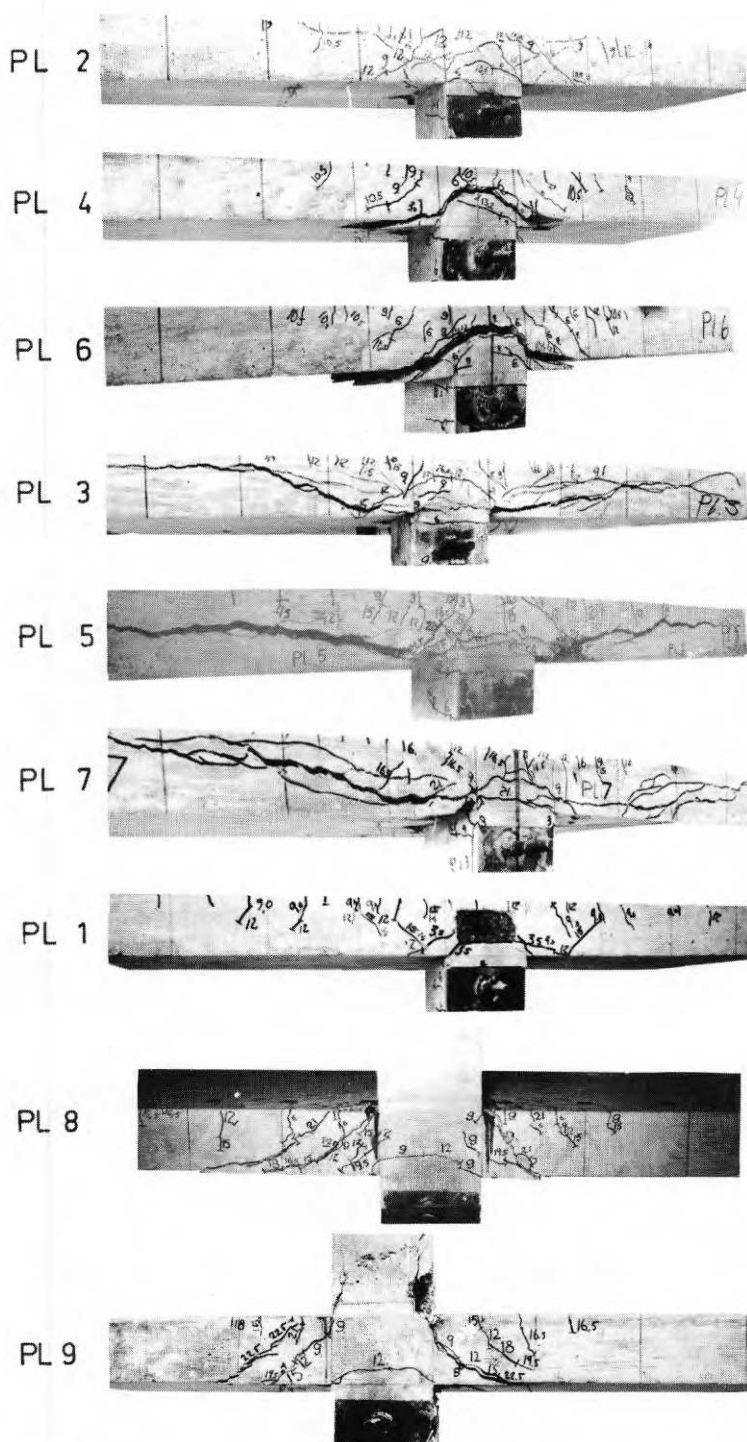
Sprickbild längs plattans understödda kant vid den pelare, där brott inträffade. Plattorna 1-3 saknade skjuvarmering. Plattorna 3, 5, 7, 8 och 9 hade dubbelt så stor mängd armering som plattorna 2, 4 och 6. Avståndet mellan de inritade linjerna är 20 cm.
